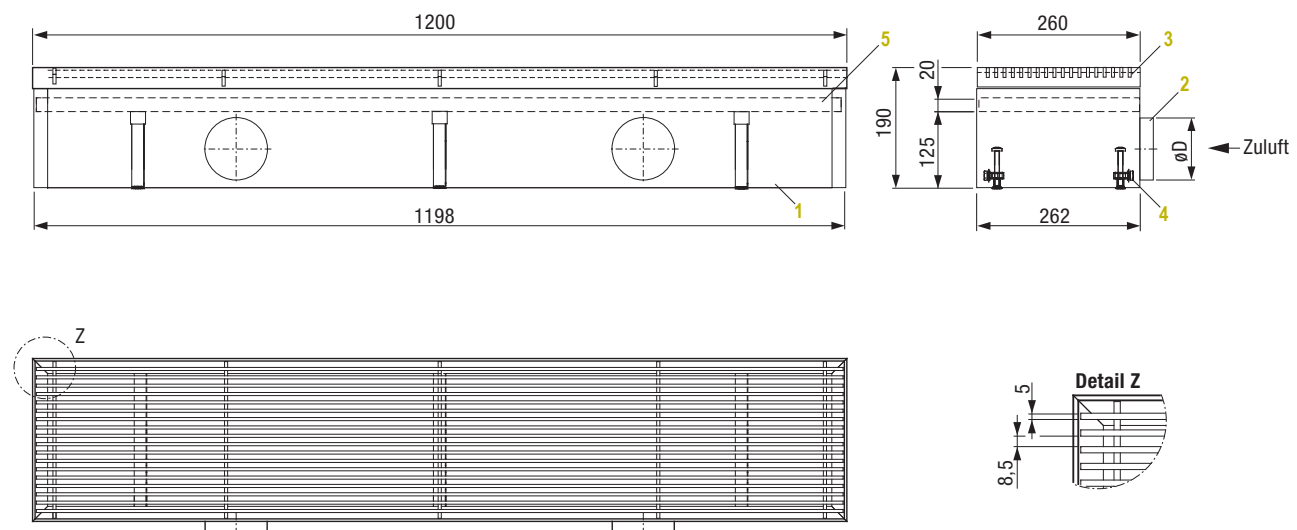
Standardabmessungen Rechteckiger Bodenquellauslass
